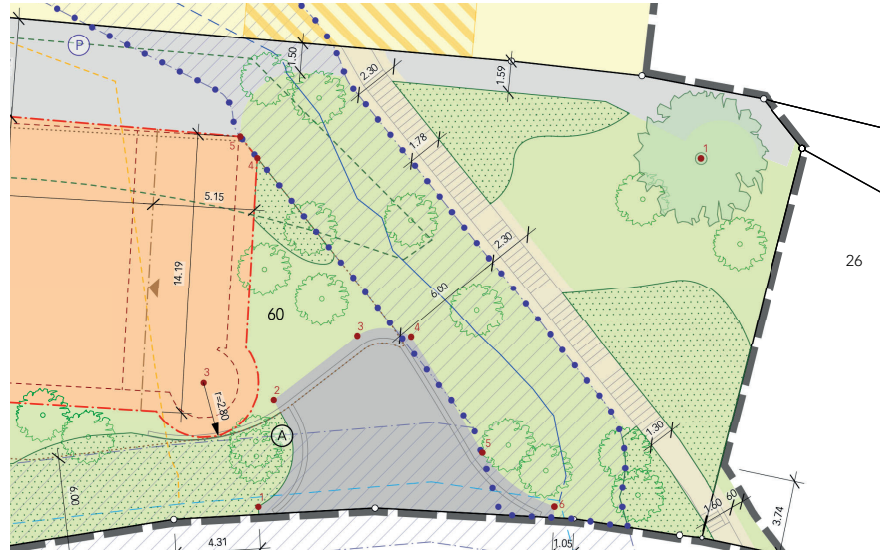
Überbauungsplan Stand Beschlussfassung, resp. Genehmigungseingabe (Juli 2024)
